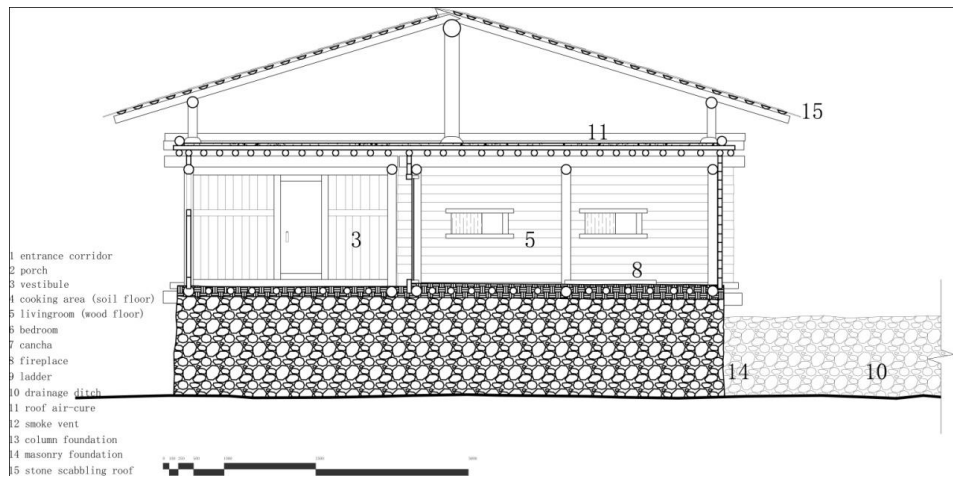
秋那桶村嘎干堂组何宅正屋 2-2 剖面图
